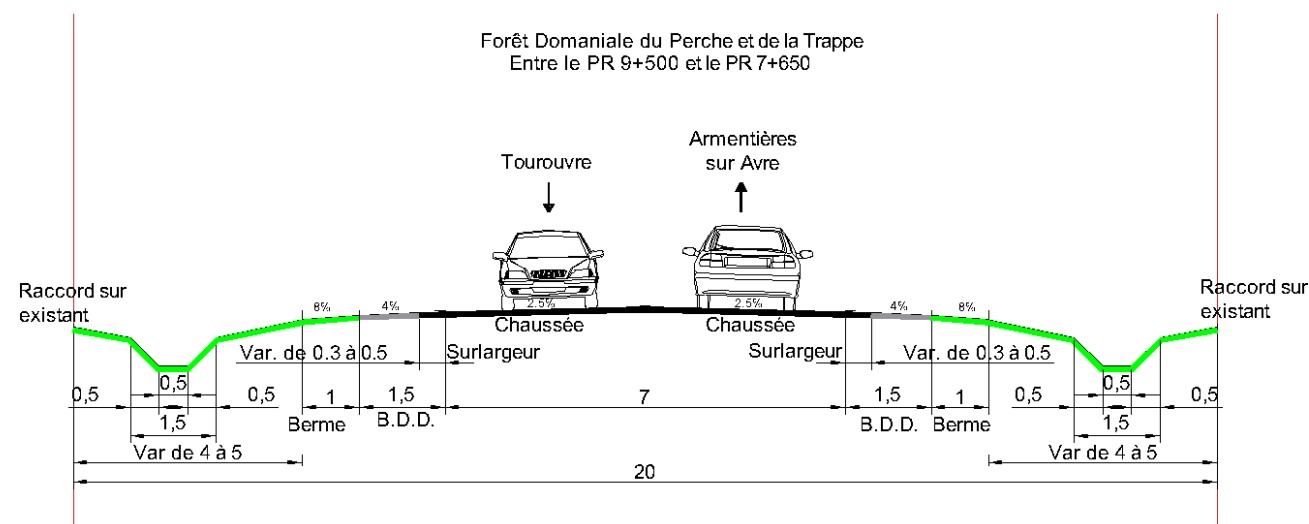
Profils en travers type – section 3 (source: SEGIC)
